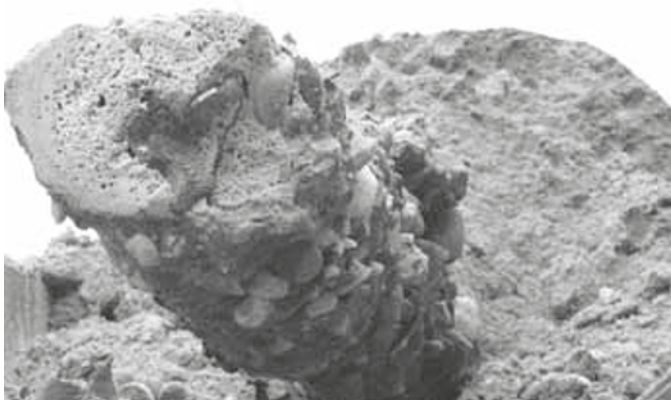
Corpo d'iniezione DRILL DRAIN® escavato.
